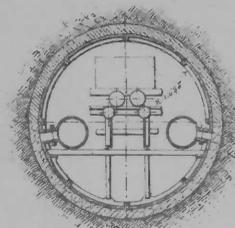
Cuvelage en maçonnerie de béton au mortier de ciment
